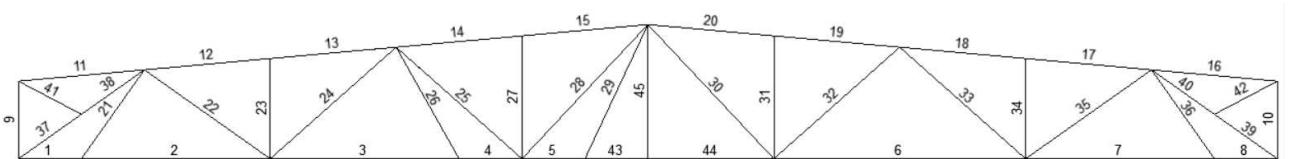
Схема стропильной фермы с номерами элементов
